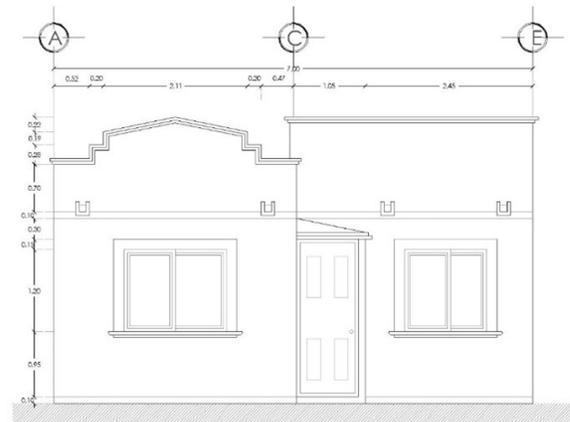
Fachada principal de la vivienda prototipo Roma-106. Fuente: Los autores
